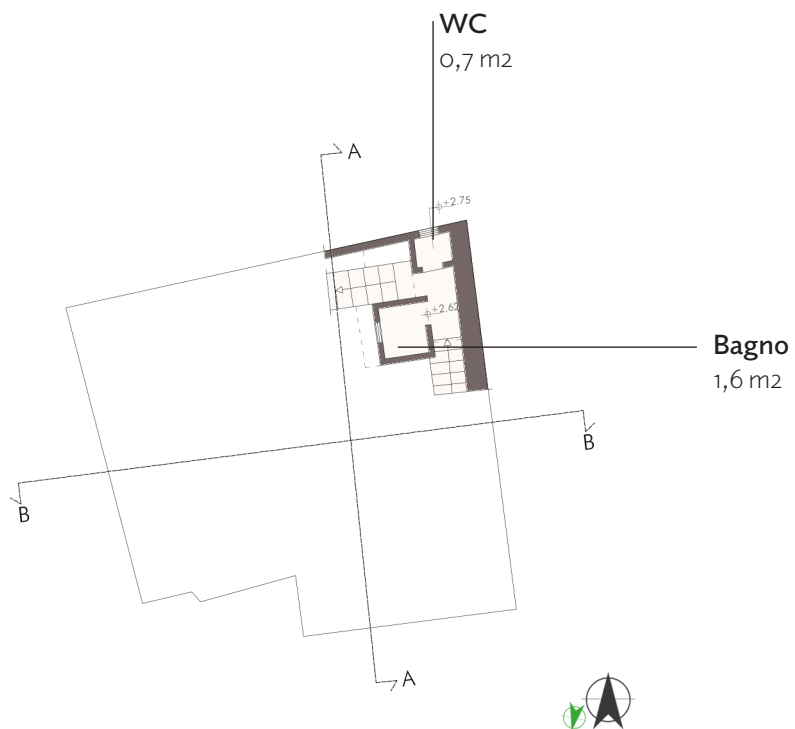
Pianta del piano intermedio. Scala 1/200
